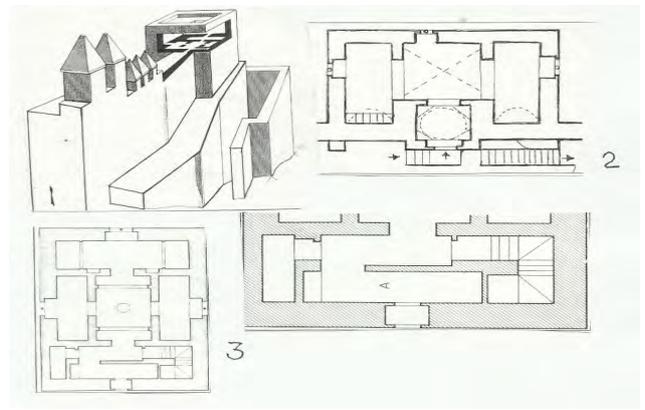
1, 2, planta y sección de la torre del Candil. Arriba a la derecha planta de la Torre de Muhammad en el sector de acceso a la Casa Real Vieja de la Alhambra.
